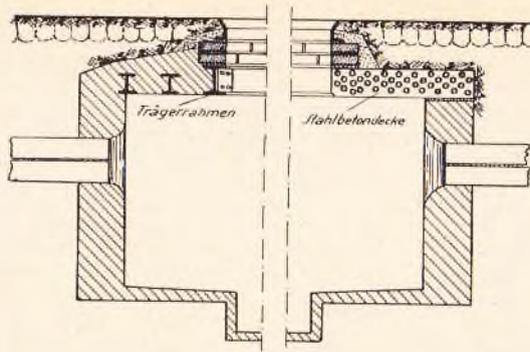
Kabelschacht a) mit Trägerrahmen b) mit Stahlbetondecke
